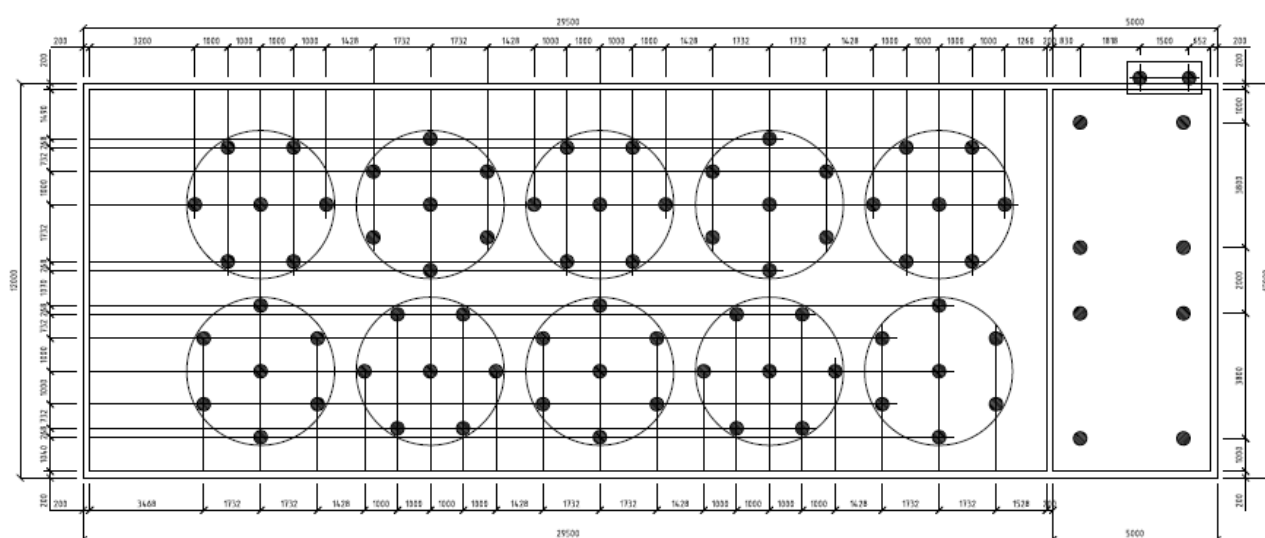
Vista in pianta delle fondazioni del bacino parco serbatoi di acido cloridrico.
